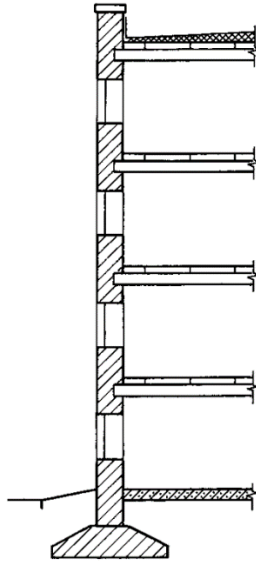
Сопряжение наружной стены с плитами перекрытия и покрытия
